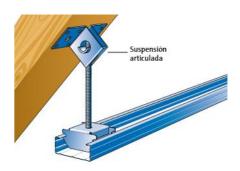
Detalle anclaje perfilería de falso techo en par de Madera de la cubierta. Fuente: Techos suspendidos continuo Placo
